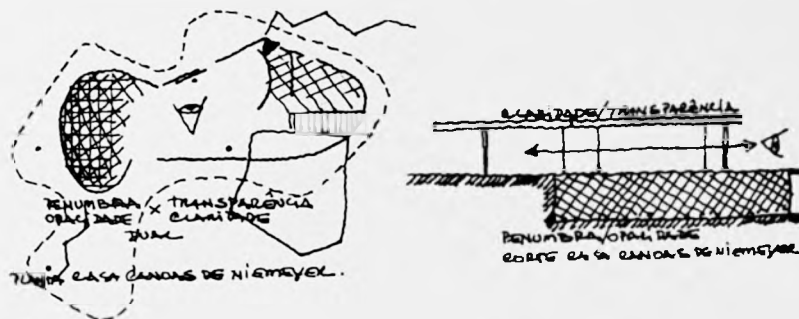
Croquis da planta do térreo e corte transversal da casa de Canoas.
